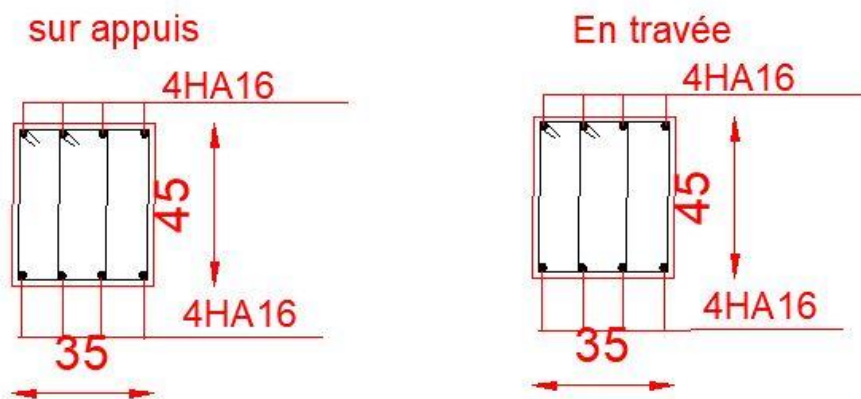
Schéma du ferrailage de la poutre secondaire.
